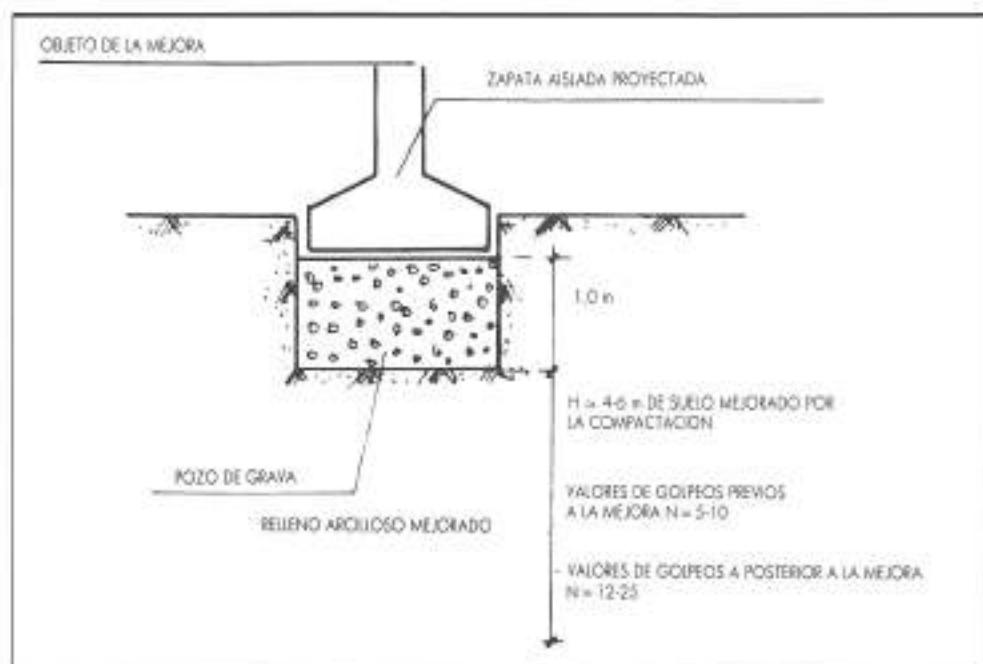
Zapata aislada apoyada sobre un colchón de grova.
